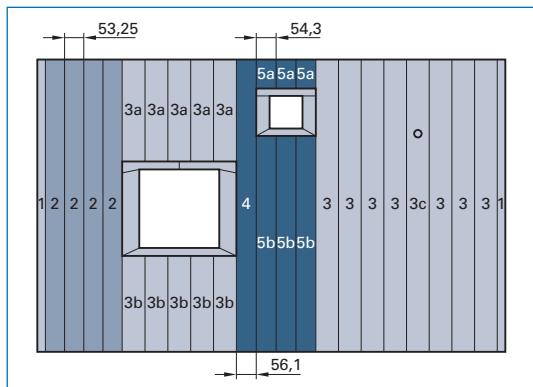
Bahnenaufteilung mit Einbindung der Dachdurchbrüche einschließlich der Verlegenummern, mit AutoCAD erstellt
